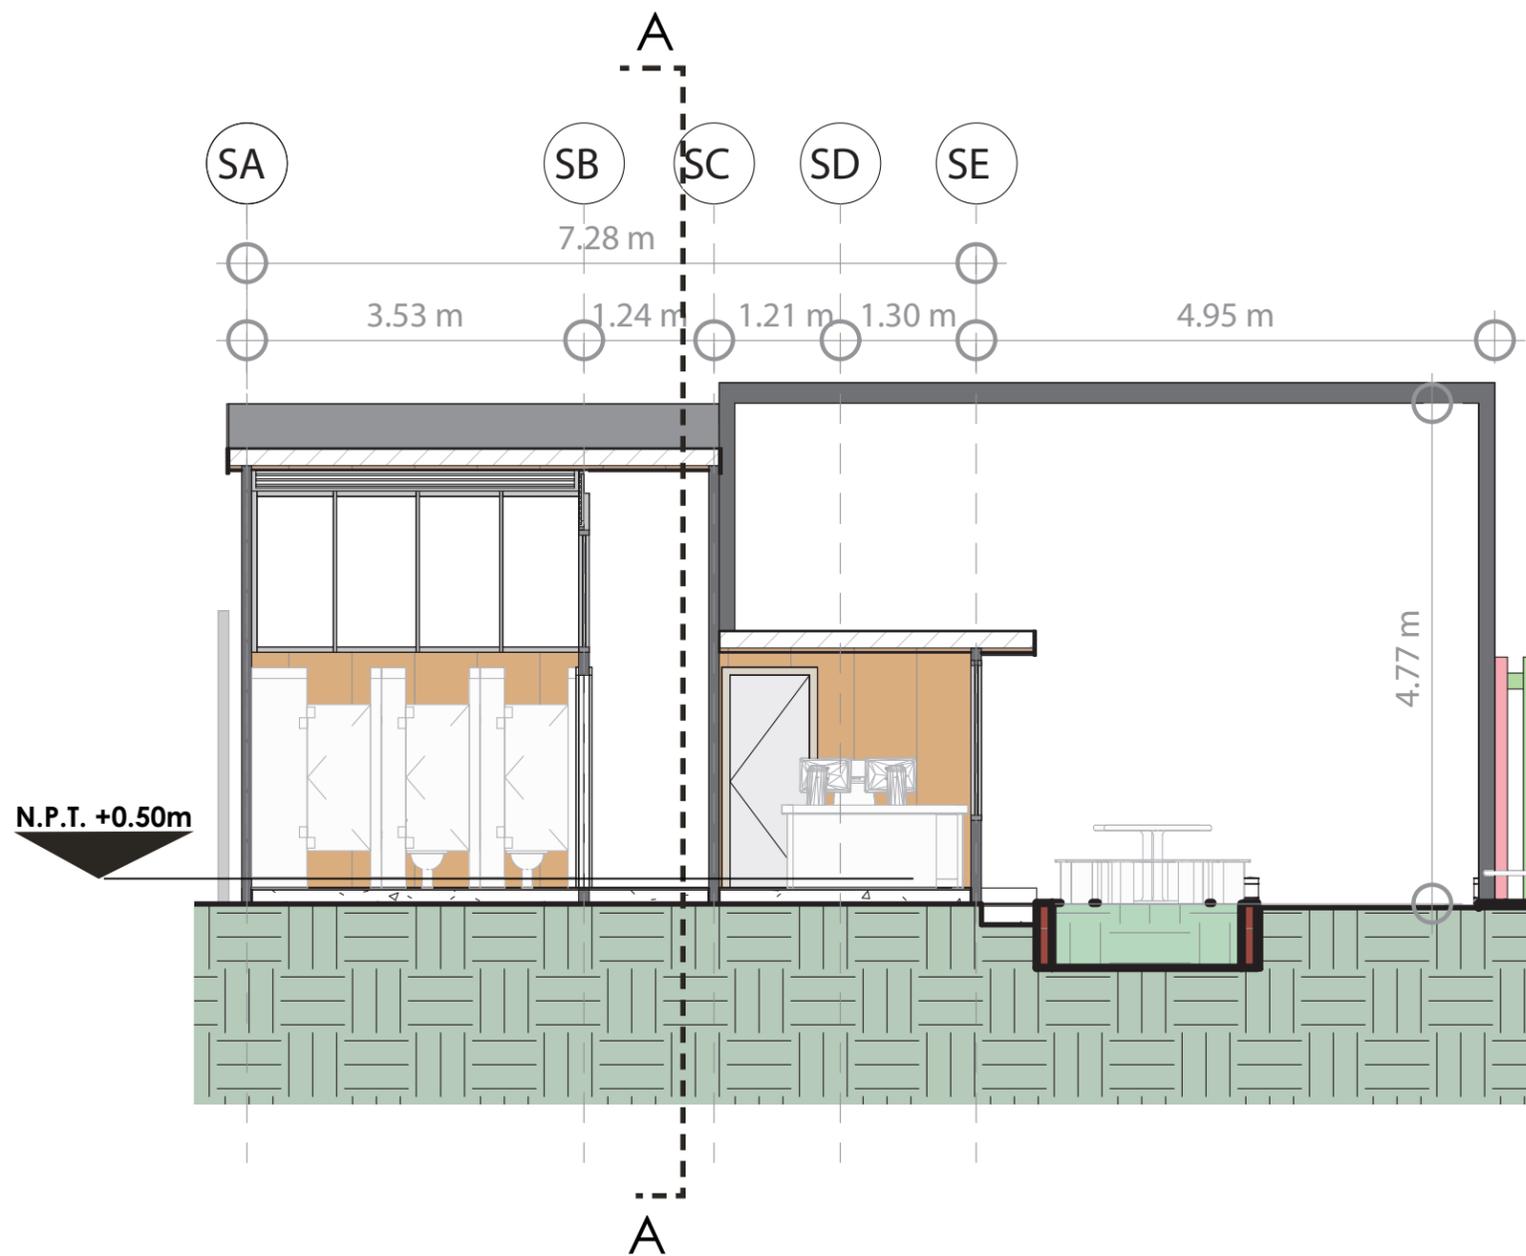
Sección B-B de bloque de servicios. Fuente: Propia.
